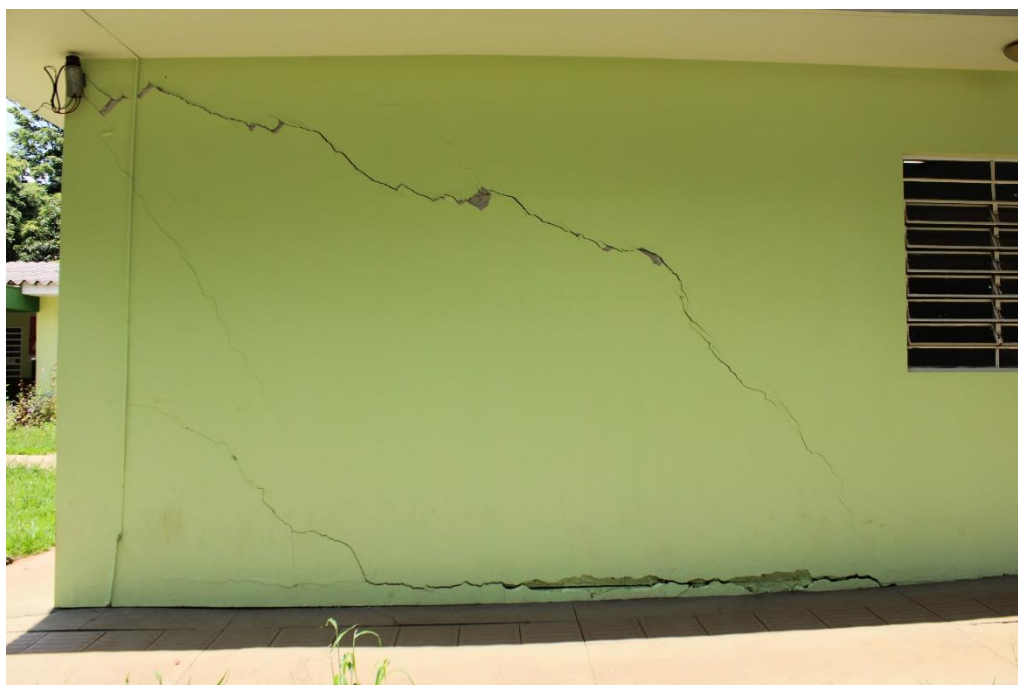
Vista parcial da Fachada Frontal (região da coordenação – sala 53), destacando lesões (fissuras e trincas) em alvenarias.
